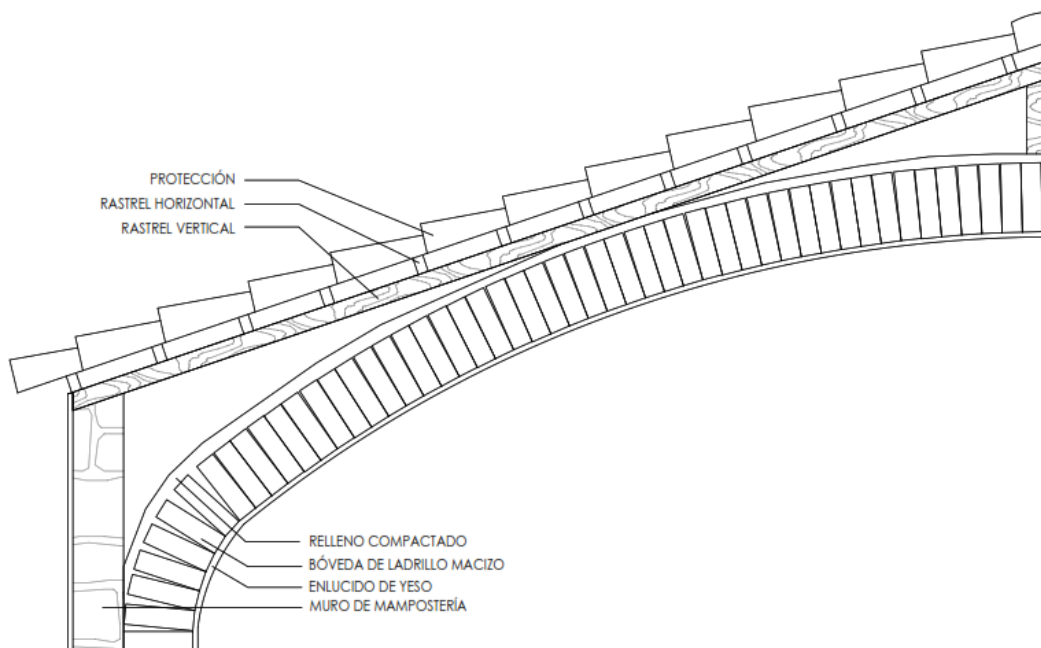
Ermita: solución constructiva de la bóveda rebajada y cubierta.
